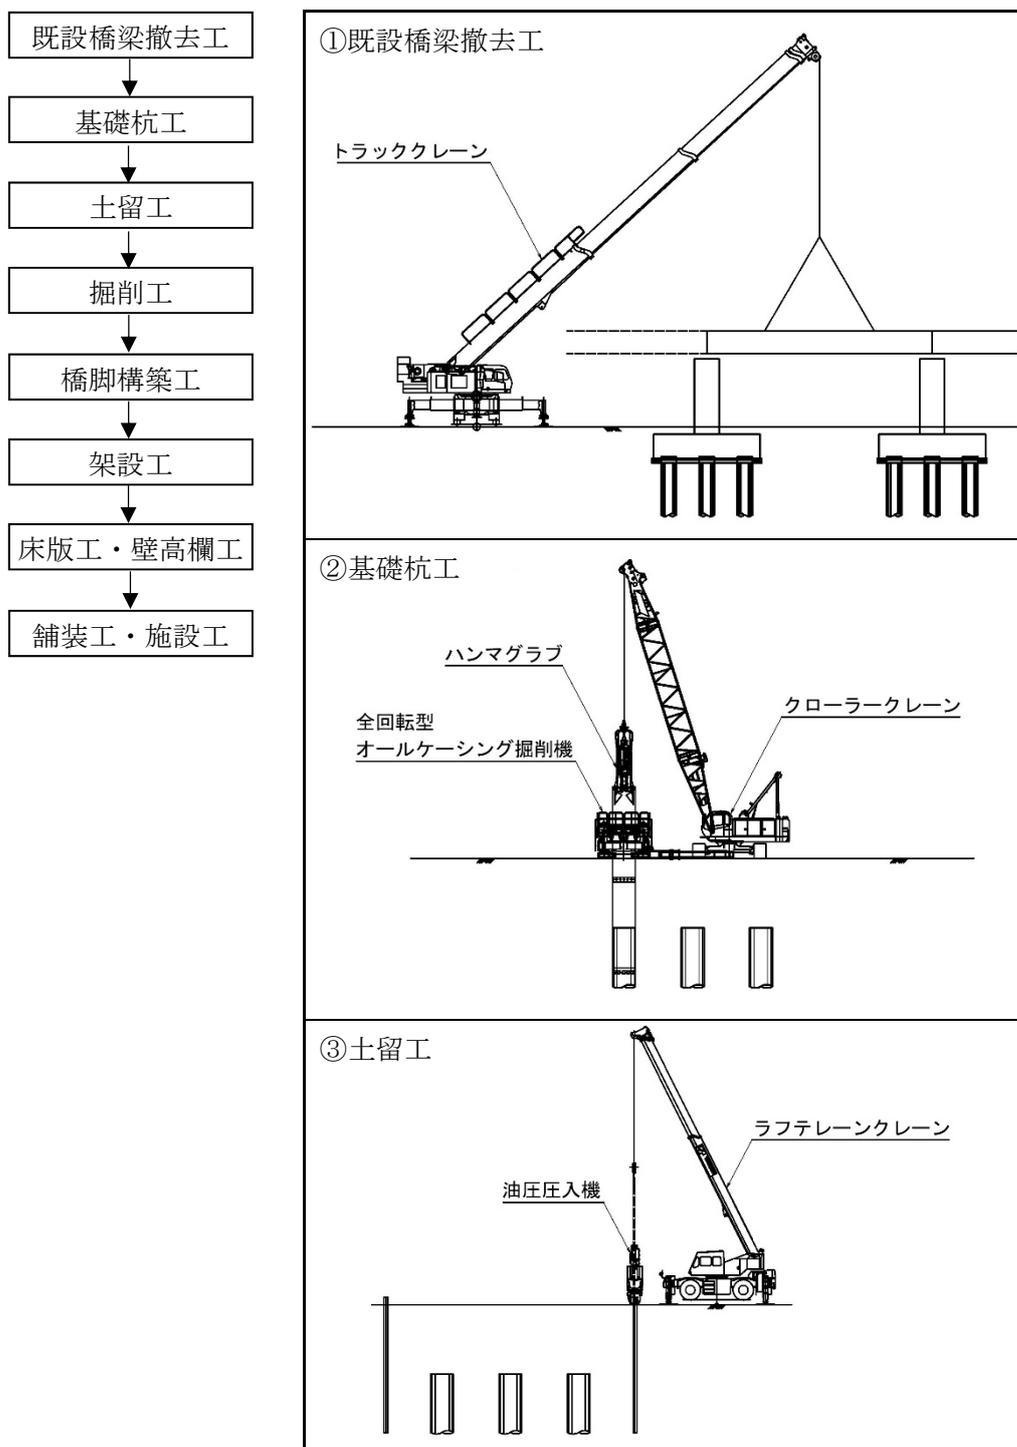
(1) 高架 (陸上部) 工事の施工手順
